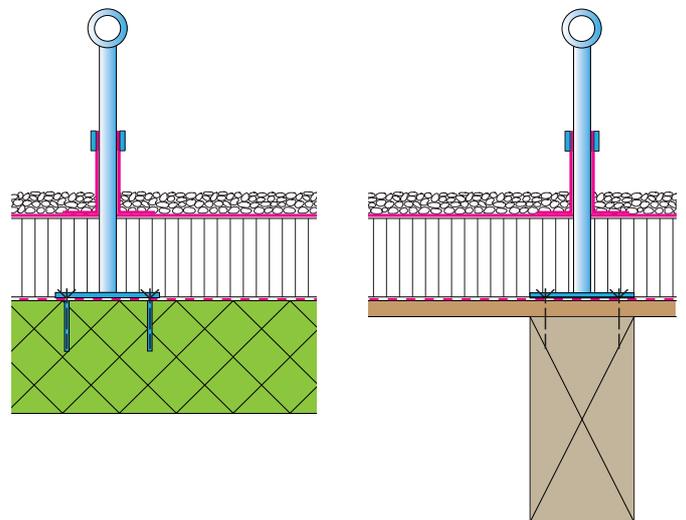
Classe d'équipement 1 : PAI monté sur un toit plat avec isolation thermique, variante sur une charpente et sur du béton
